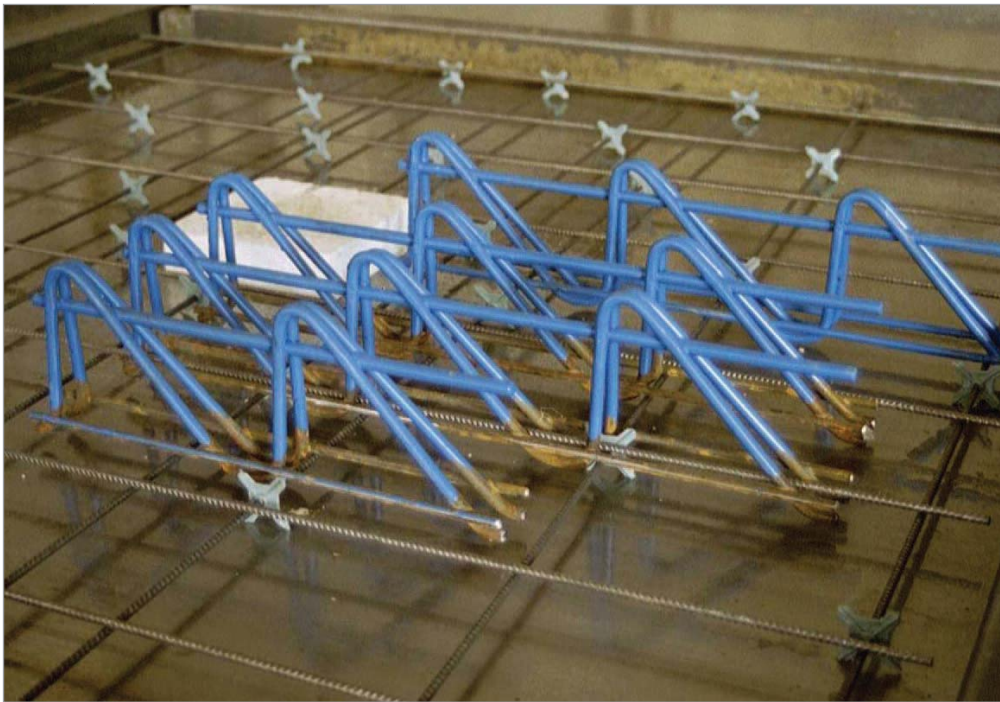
Einbau der Filigran-Durchstanzbewehrung im Fertigteilwerk
